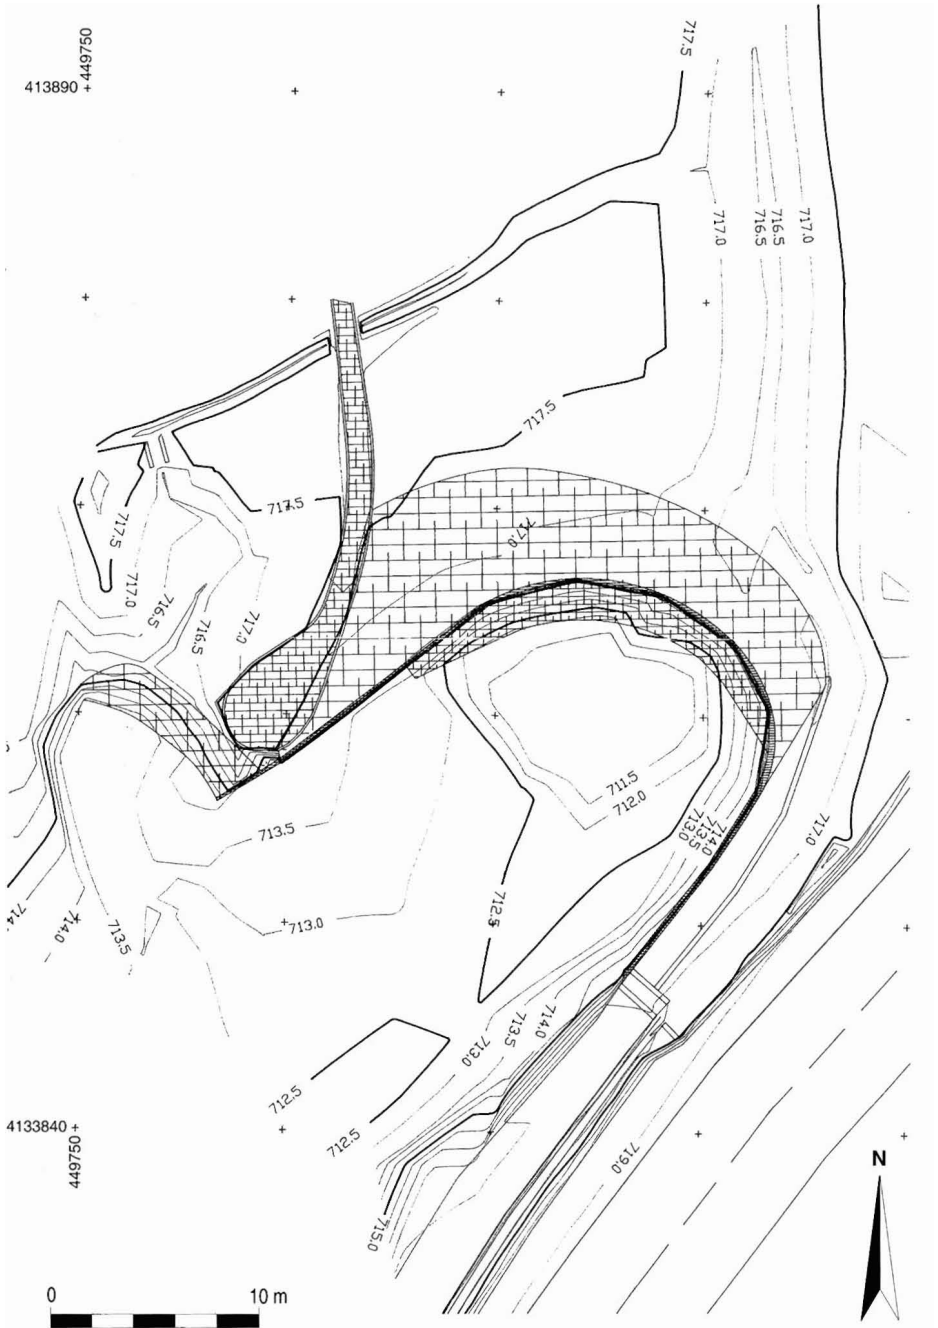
Planta topográfica de la Presa de Barcinas.
